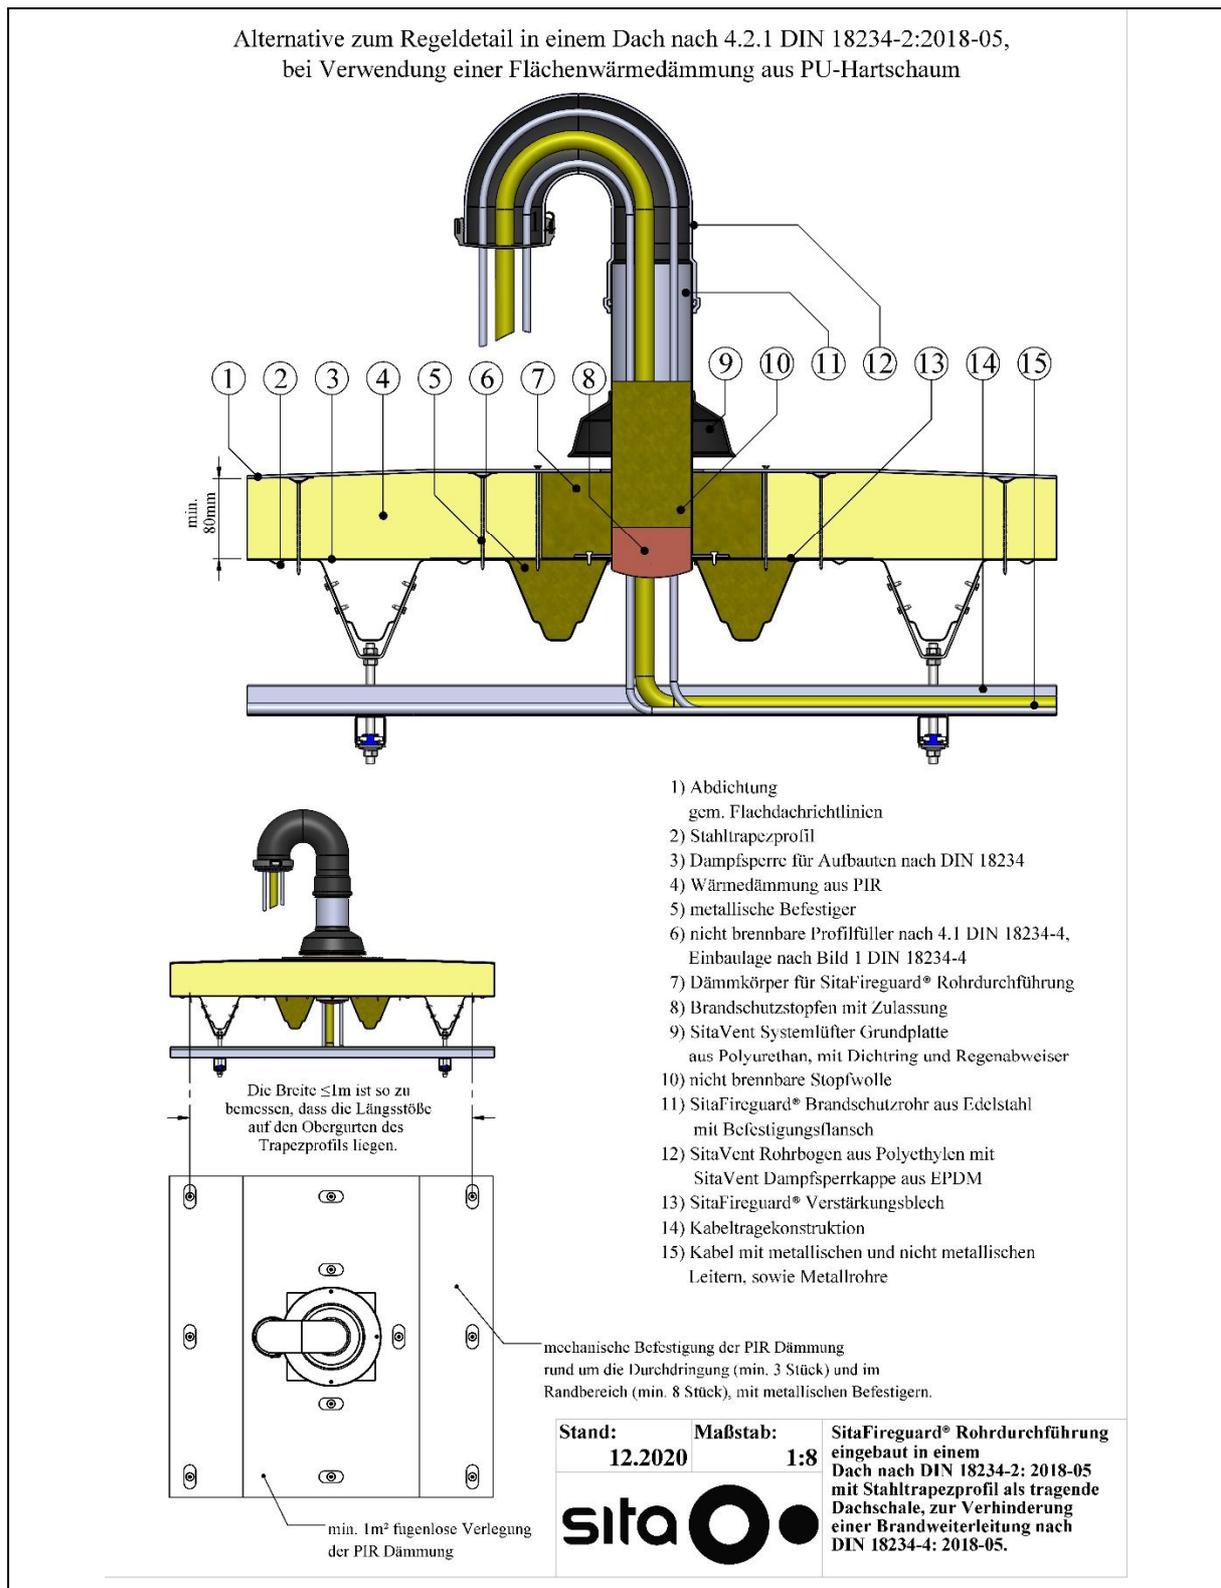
SitaFireguard® Rohrdurchführung in einem Dach nach DIN 18234-2 bei Verwendung eines Dämmkörpers und direktem Anschluss der Flächenwärmedämmung aus PU-Hartschaum
